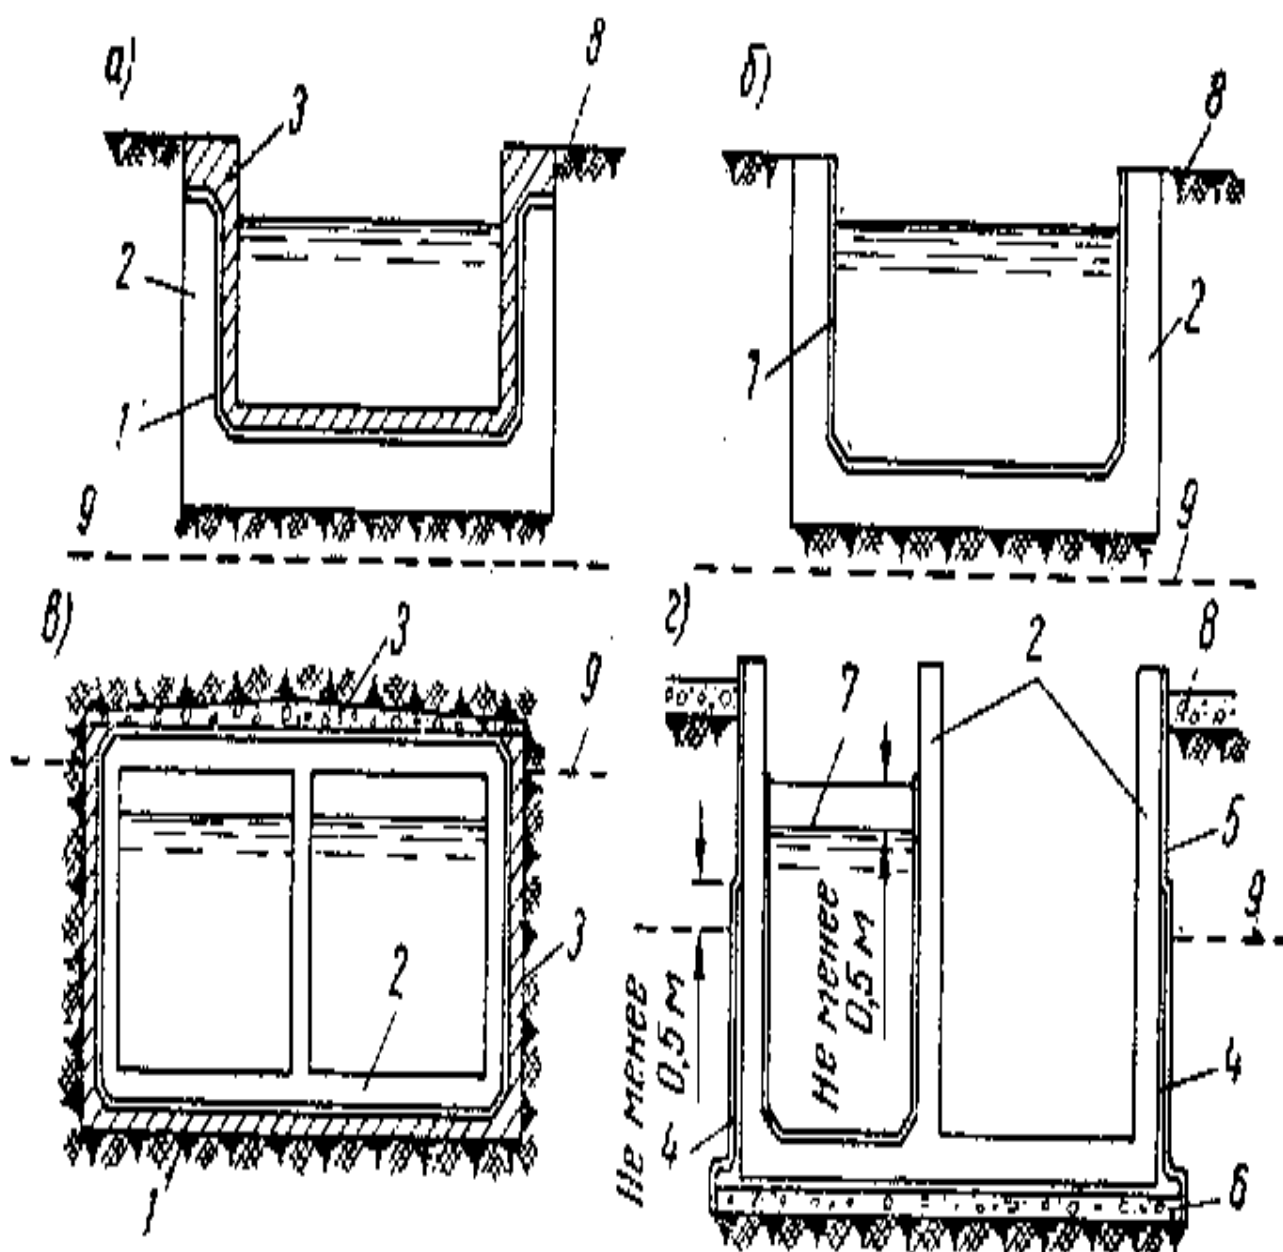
Гидроизоляция водонаполненных сооружений:
